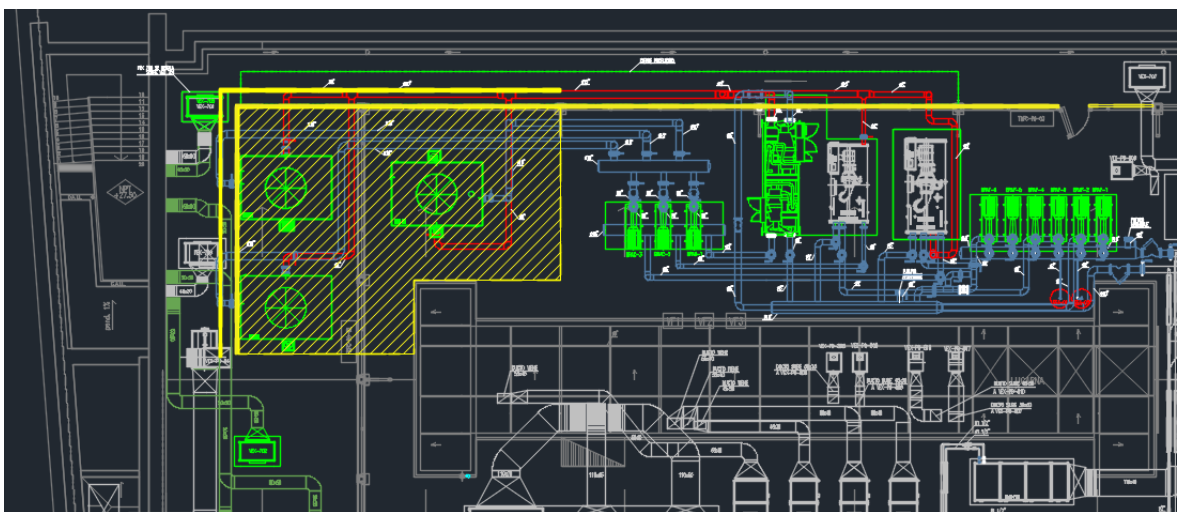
Vista en planta de la central de frío del Proyecto, soluciones proyectadas en línea amarilla
